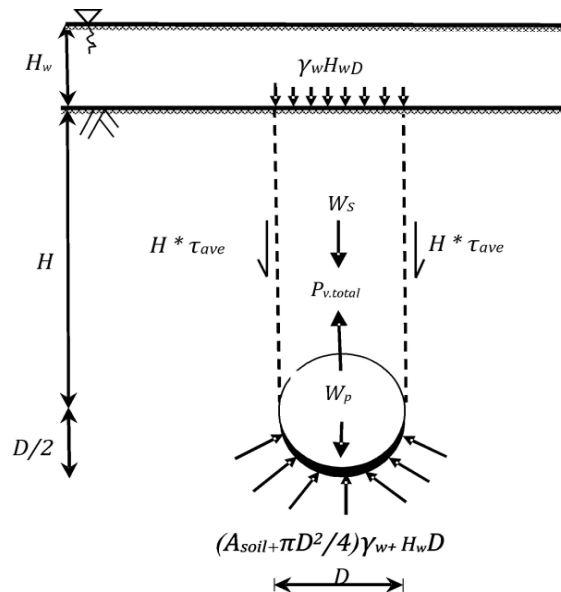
Mécanismes de soulèvement d'une conduite enterrée dans l'argile en conditions entièrement drainées
